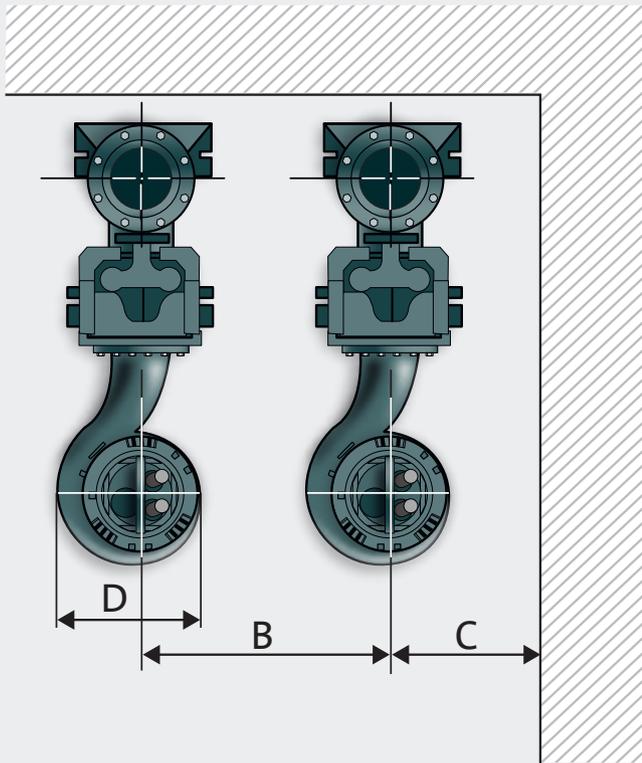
Empfohlene Einbaumaße für Tauchmotorpumpen
